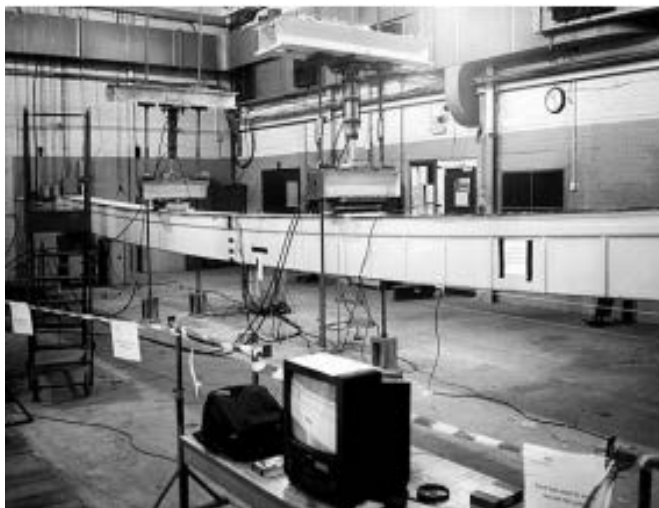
Vista general de la instalación de ensayo a escala real en Southall (cortesía de Taylor Woodrow Construction, Ltd., RU).
